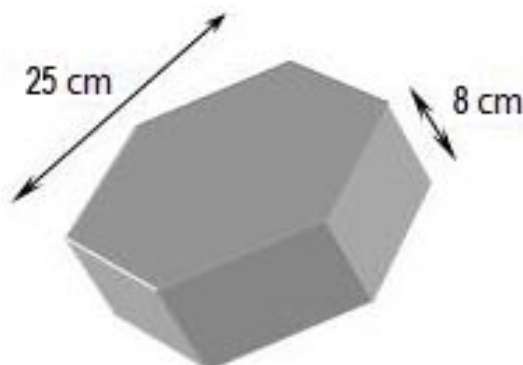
Modelo de Bloquete Sextavado de concreto com extensão de 25cm e espessura de 8cm
